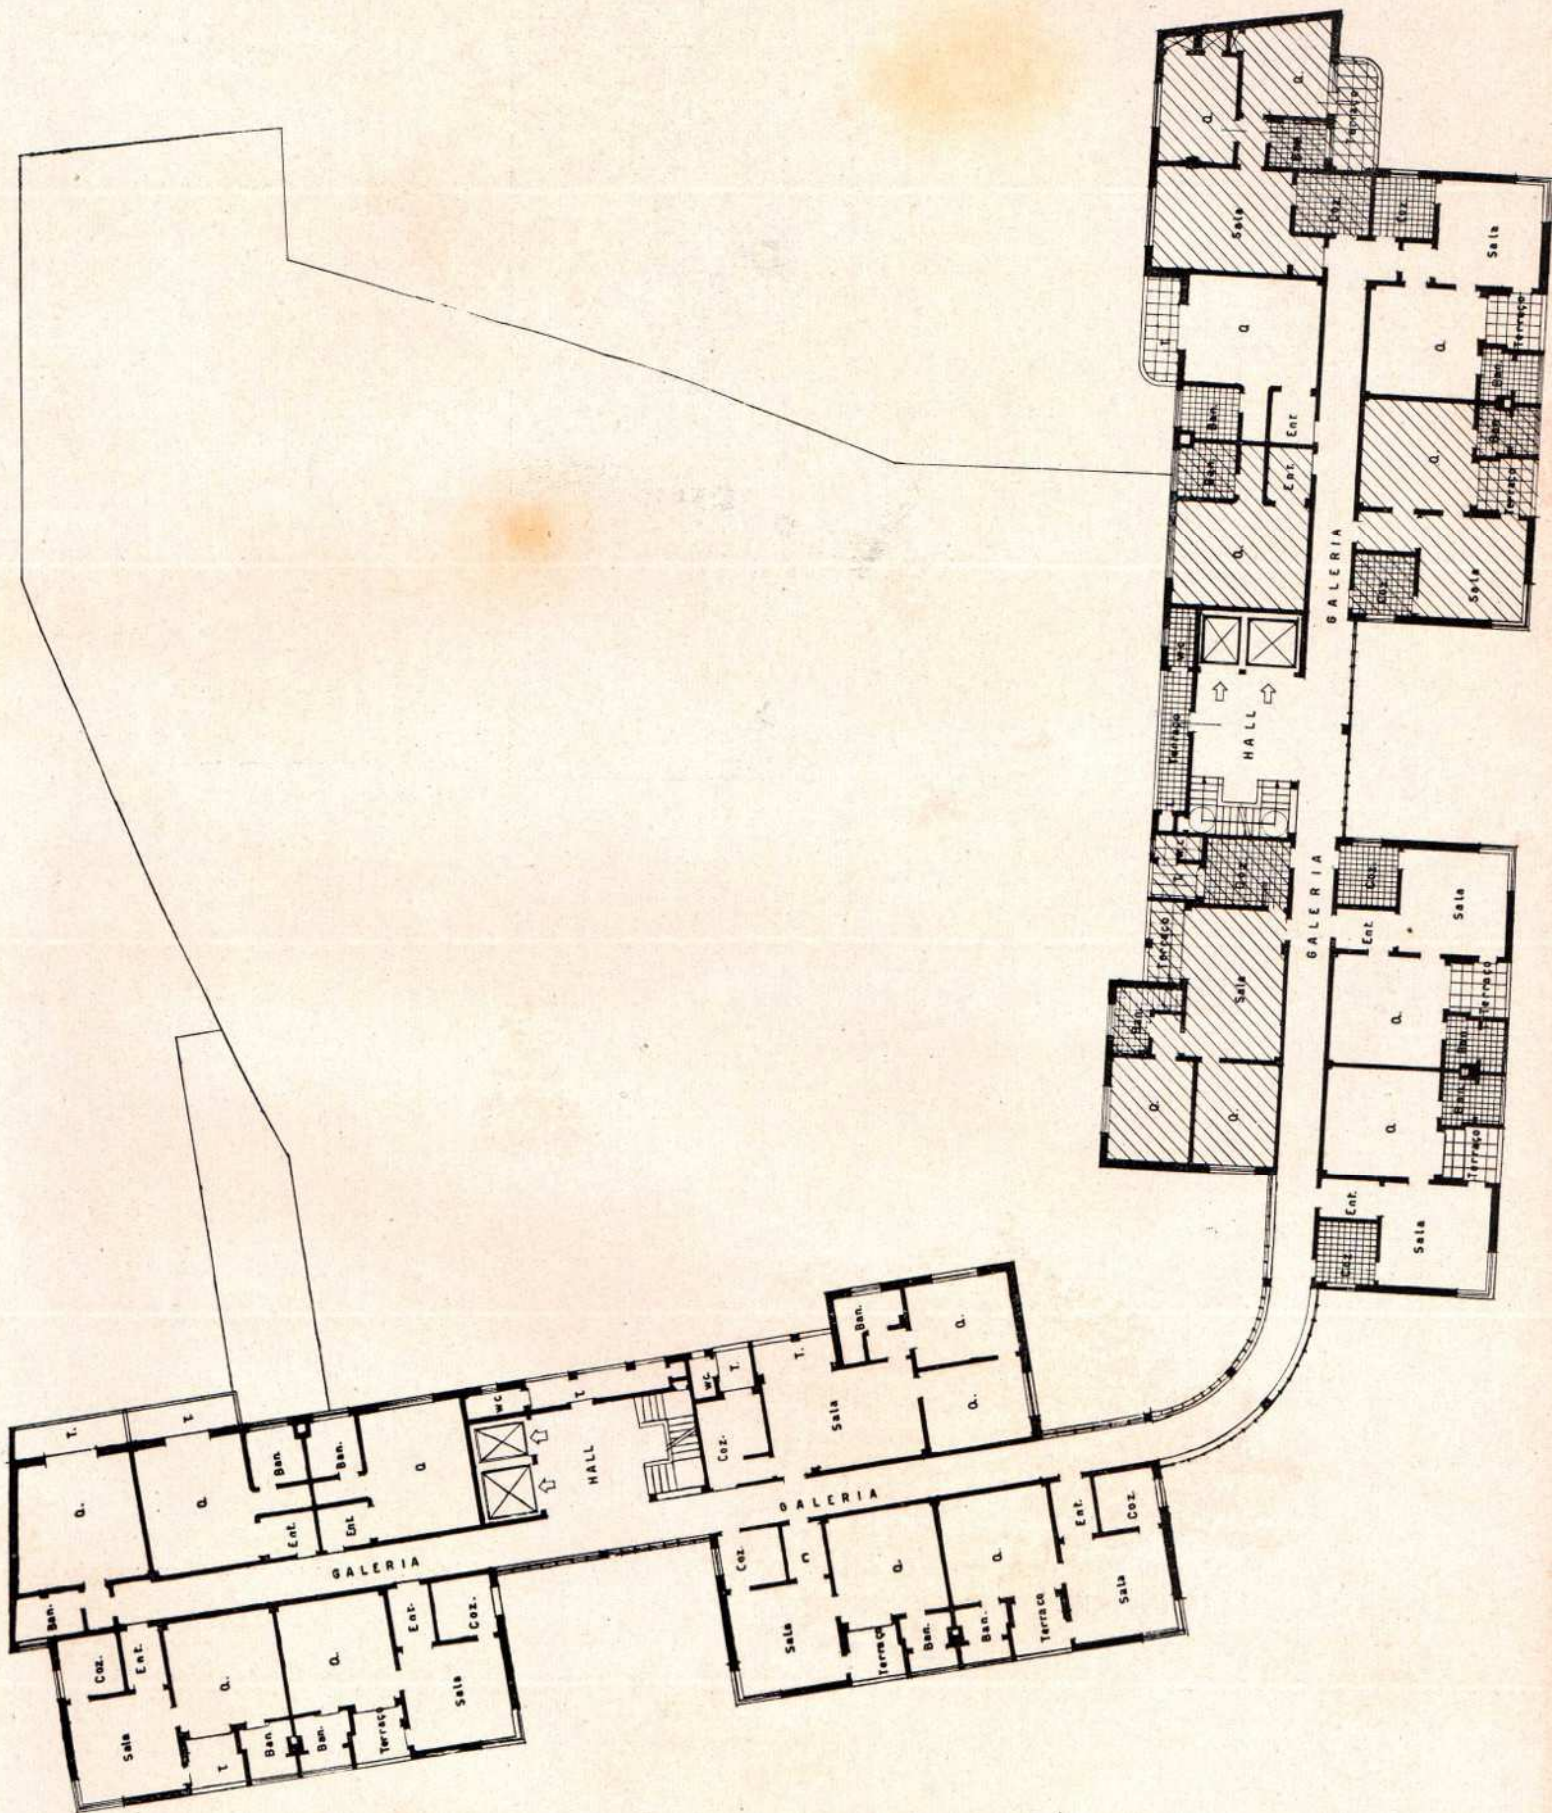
Edifício Roxy — Planta-tipo dos pavimentos superiores.
